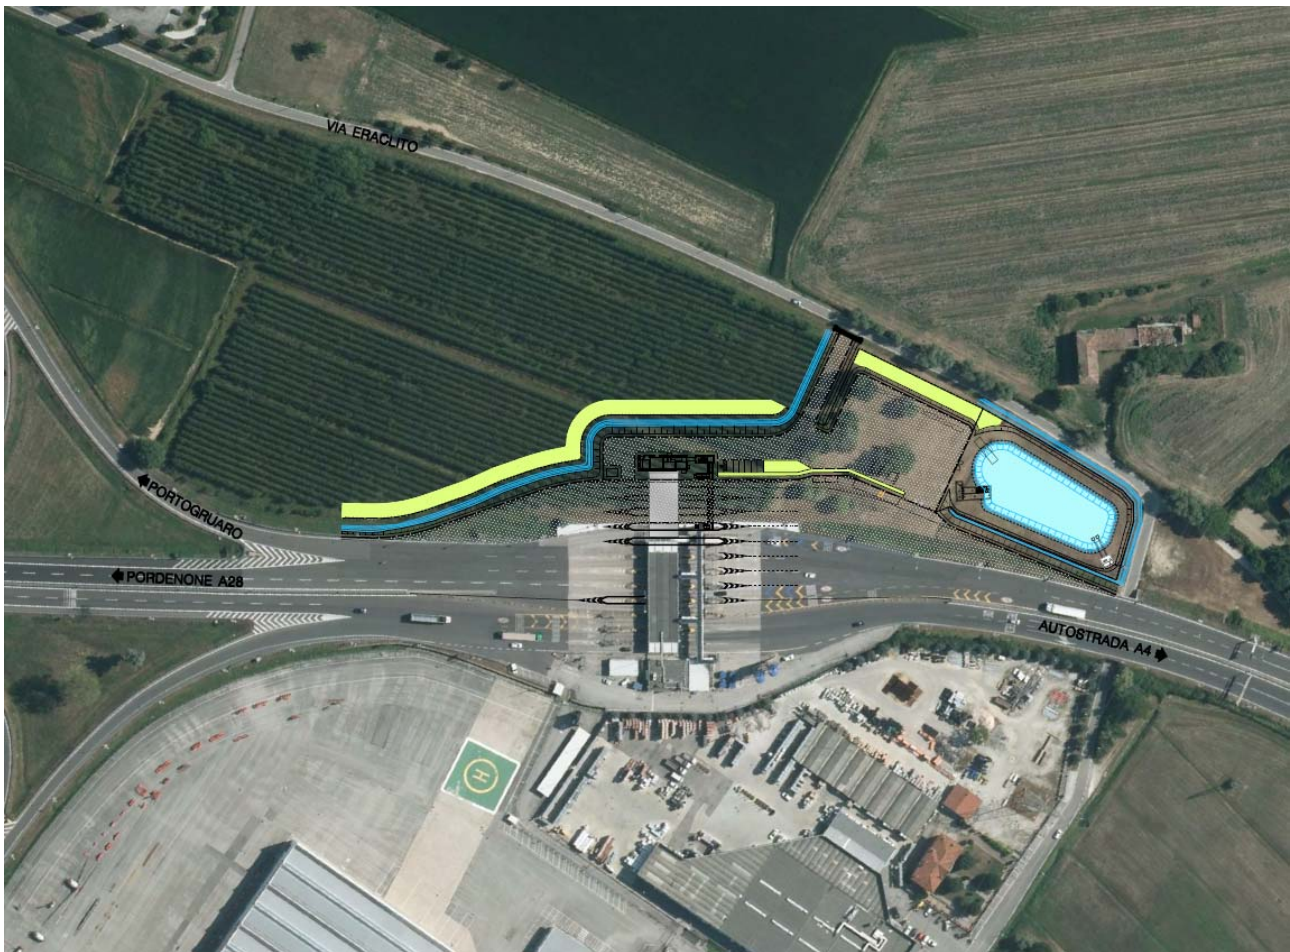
Planimetria su ortofoto con l'individuazione della viabilità ordinaria, in particolare di via Eraclito.
